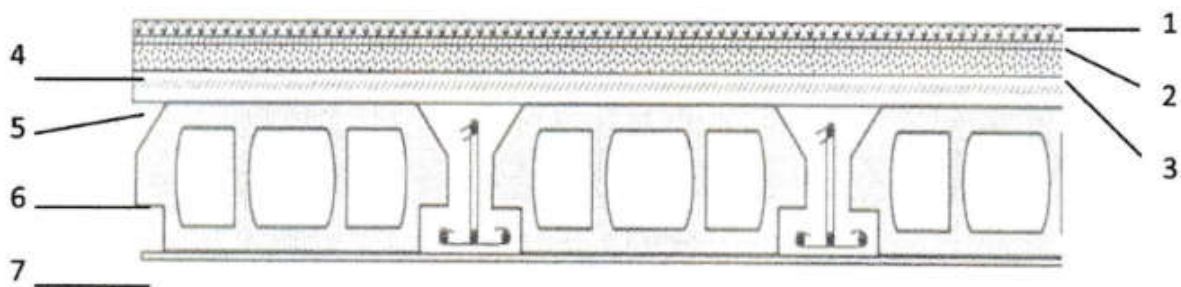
Coupe d'un Plancher à Corps Creux (plancher terrasse)
